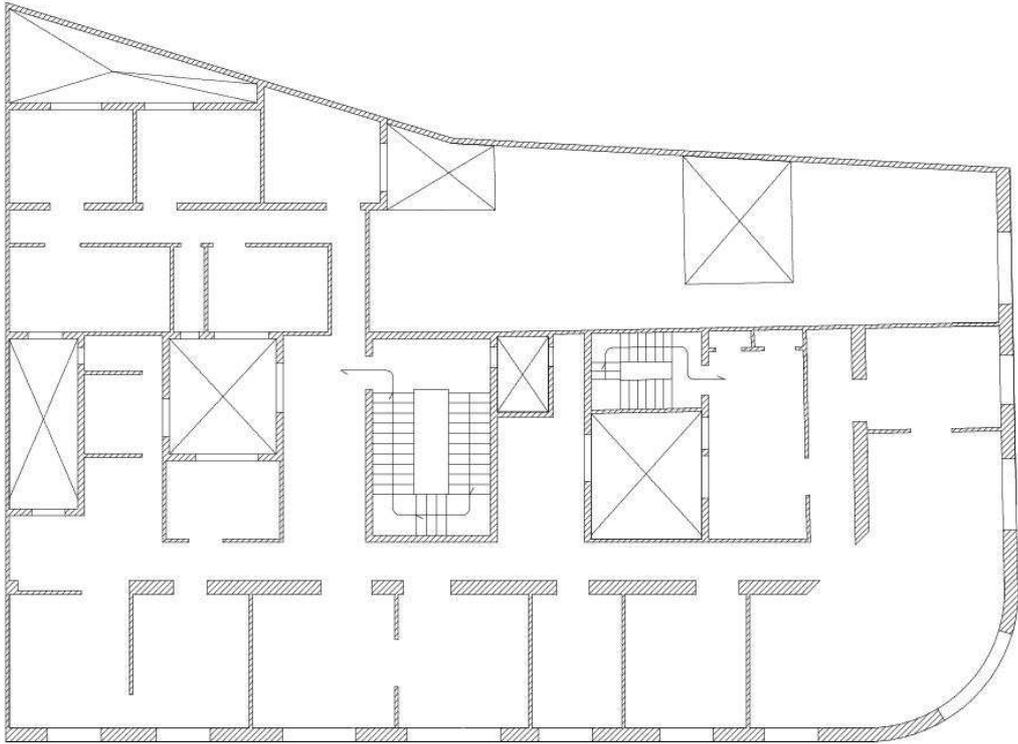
Levantamiento CAD Planta entresuelo Edificio Niederleytner. Fuente: Elaboración propia.
